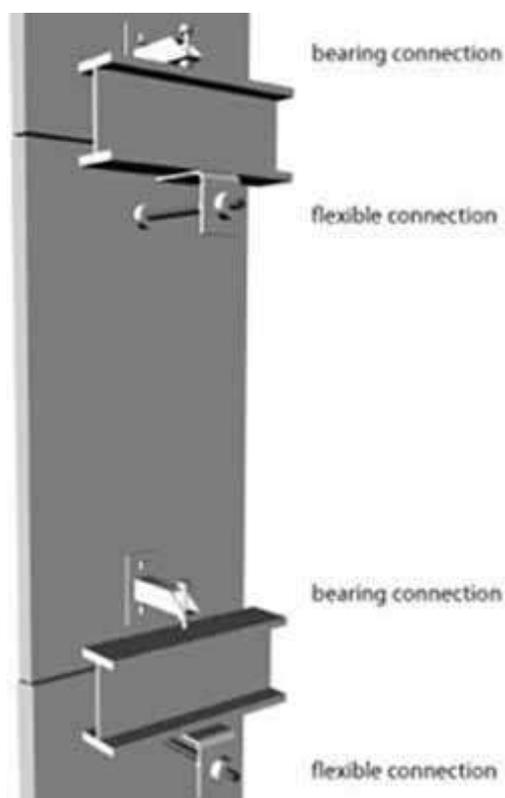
Neste arranjo, a fixação flexível ocorre na viga do pavimento superior deixando a panel sujeito a instabilidade caso ela falhe. (ARNOLD, 2009)
